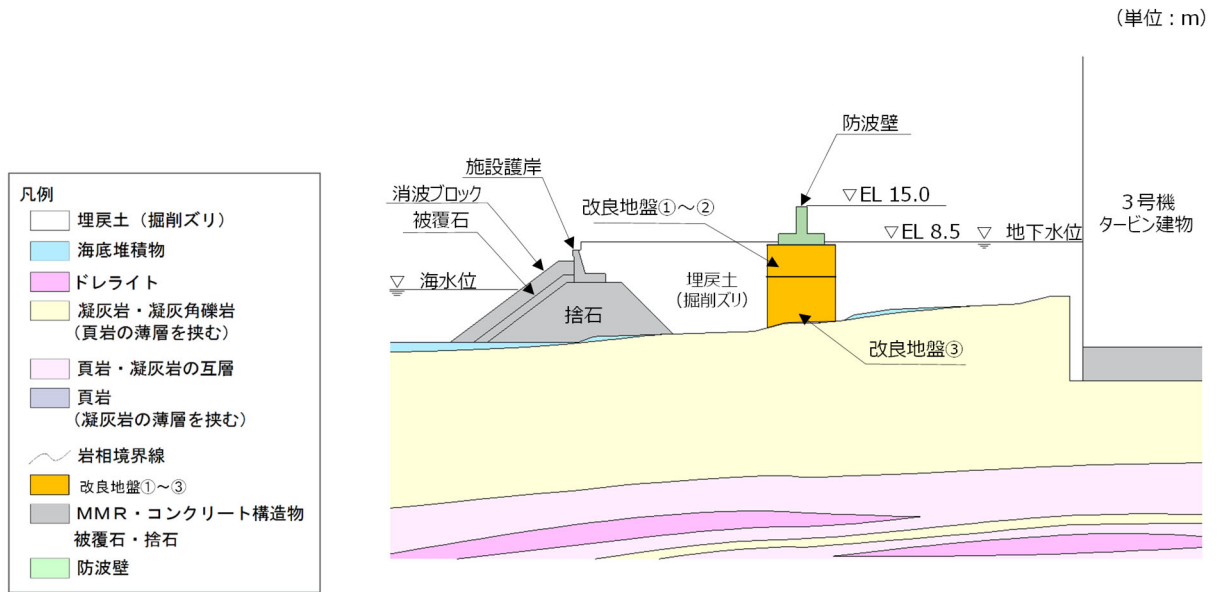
防波壁 (逆 T 擁壁) の横断面図 (④-④断面)
